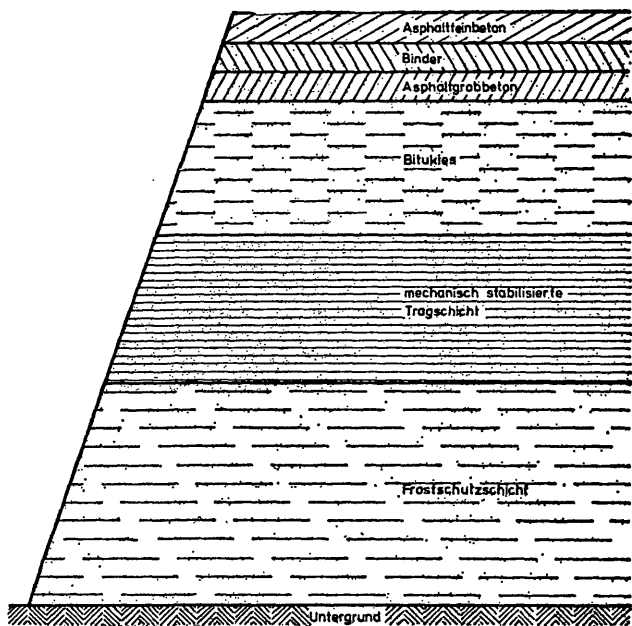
Schnitt durch eine Bundesschnellstraße
